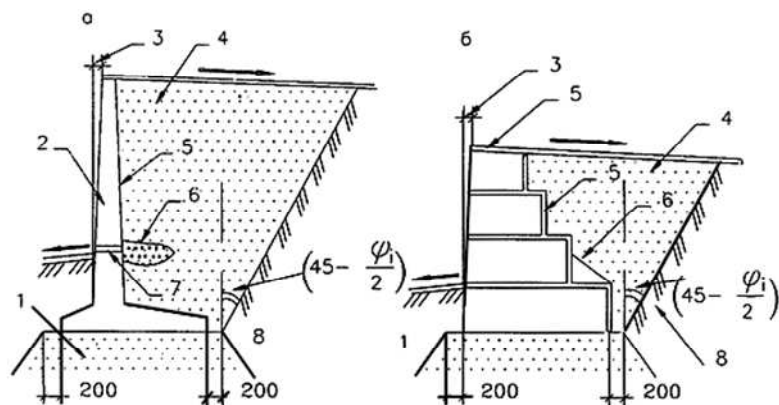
Схемы устройства подпорных стен: а – из монолитного железобетона; б – из сборных (бетонных) блоков; 1 – песчаная или щебеночная подушка; 2 – подпорная стена; 3 – строительный наклон; 4 – засыпка песком; 5 – гидроизоляция; 6 – дренаж; 7 – дренажные отверстия; 8 – естественный грунт
